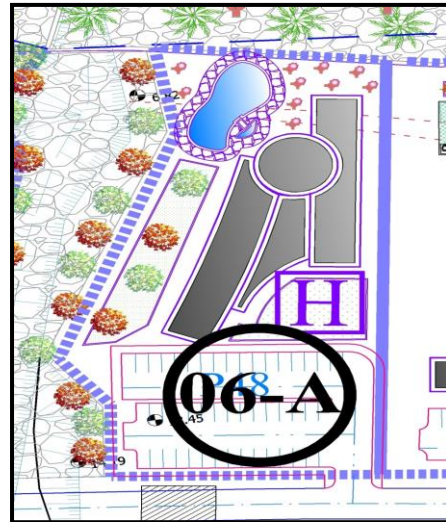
Plan de masse de l'hôtel (lot 06-A/zone A)
